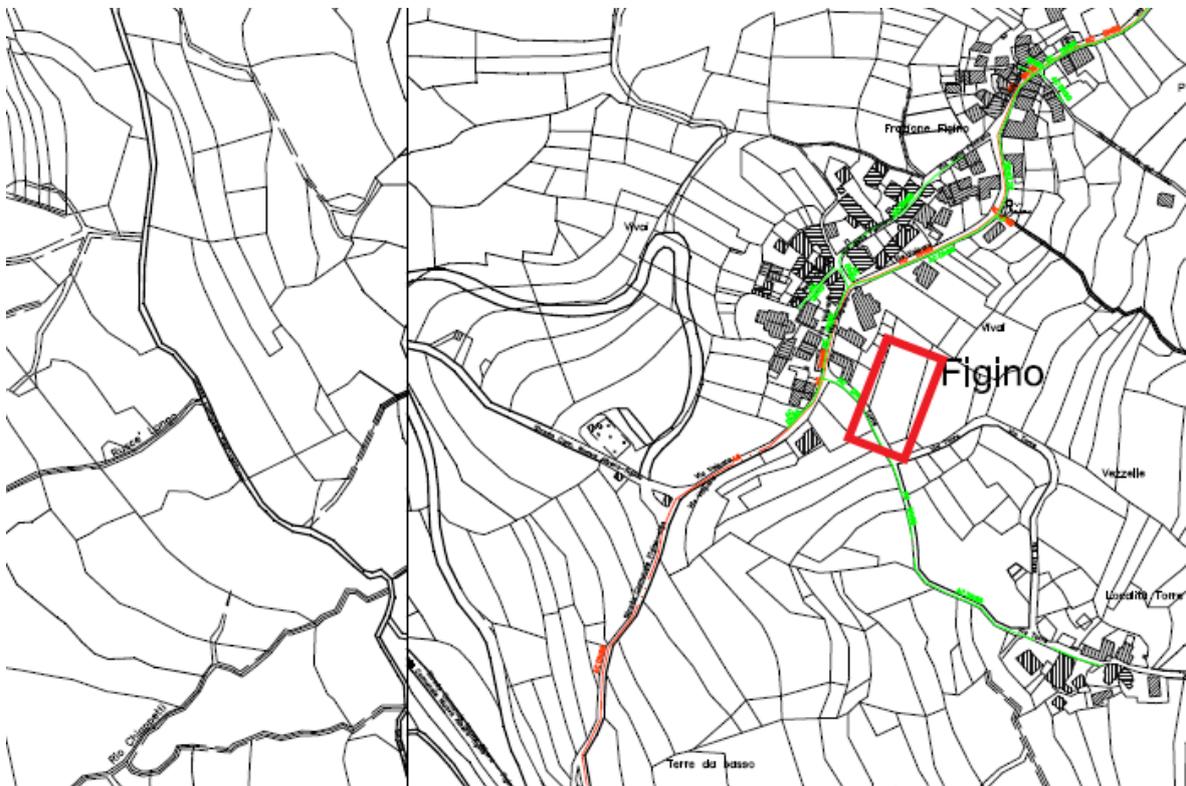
Estratto Planimetria di Rete (Tav.17a)
